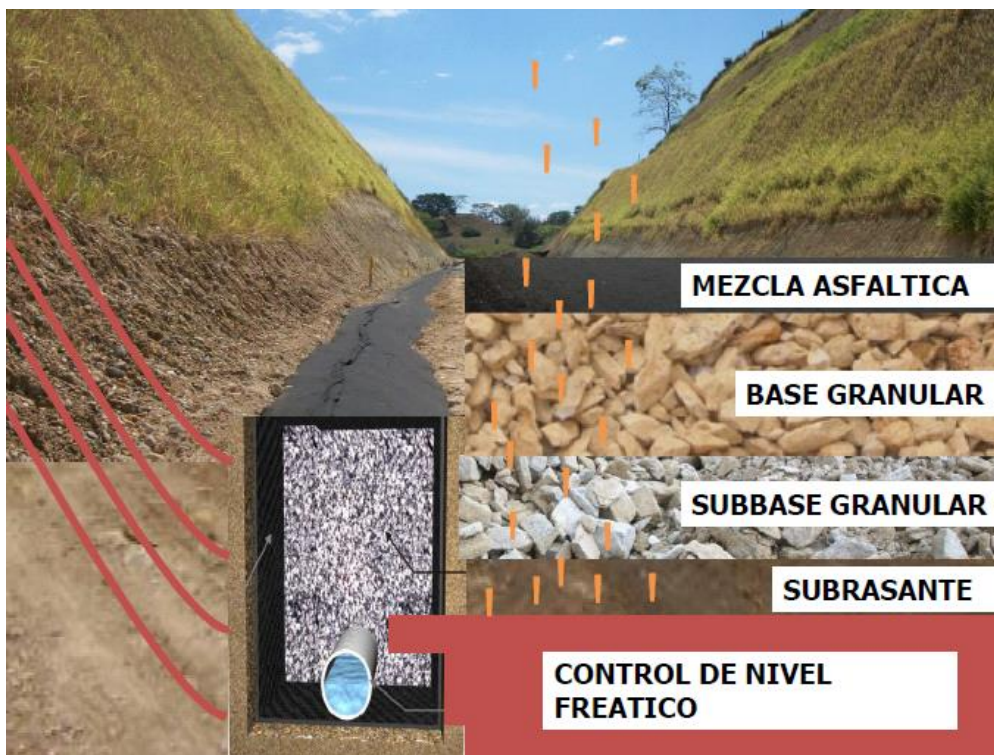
Vista real de etapa de construcción de dren tradicional con tubo perforado
